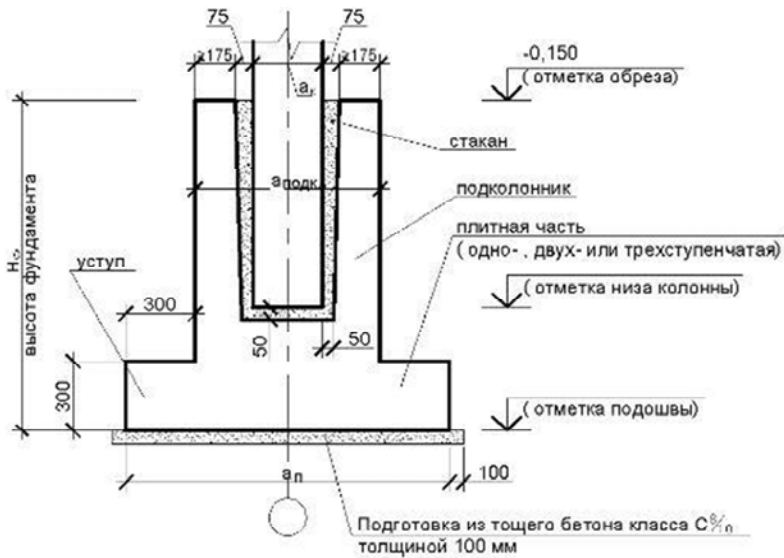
Монолитный железобетонный фундамент со стаканом под колонну
